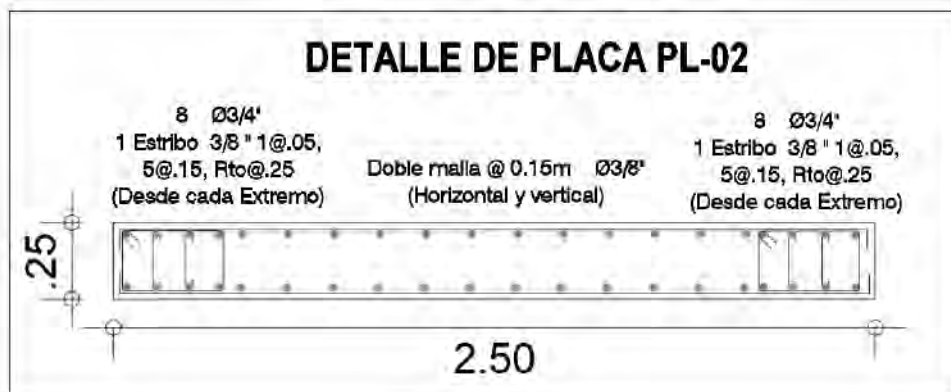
Detalle final de la placa PL-02, segunda propuesta de reforzamiento
